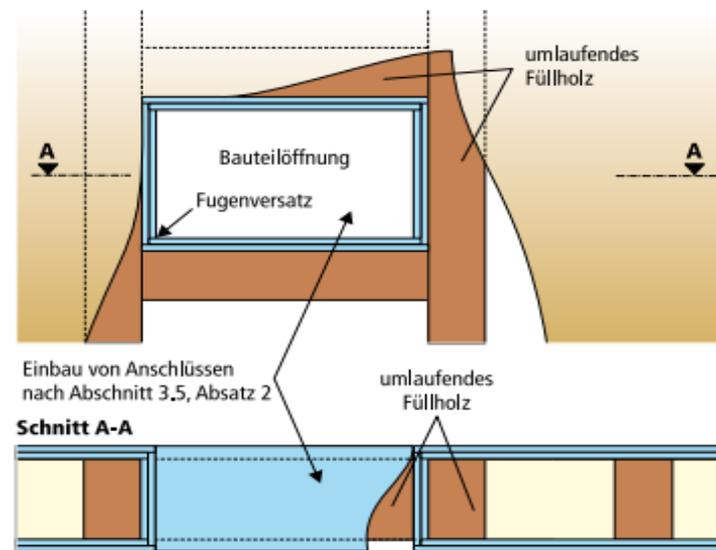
(Bild 7) Bauteilöffnung mit Brandschutzbekleidung nach Abschnitt 3.2 zum Einbau von Türen Fenstern und sonstigen Einbauten nach Abschnitt 3.5, Darstellung der Ausführung mit Fugenversatz
